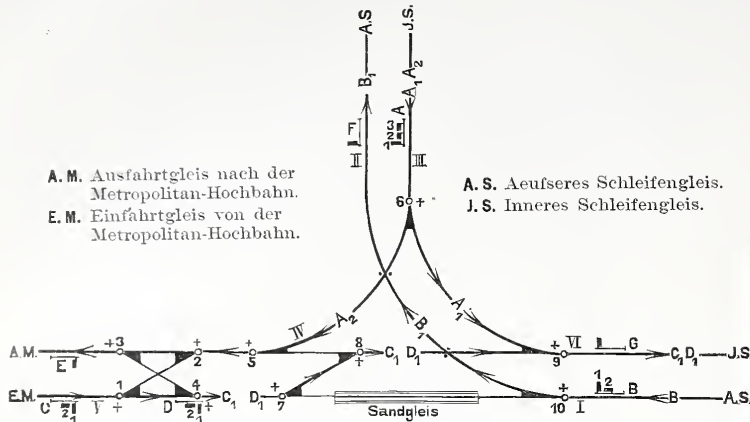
Lageplan des Metropolitan-Anschlusses.
